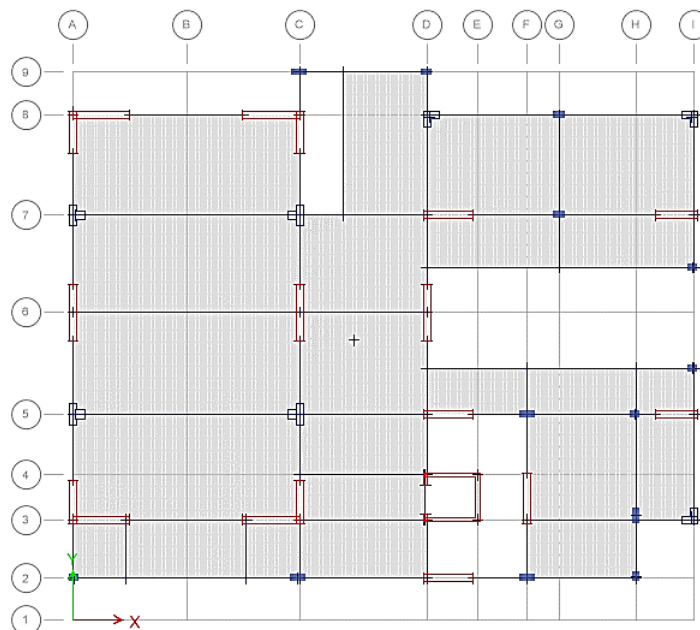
Planta Típica de Losa Aligerada (1° - 4° nivel)
